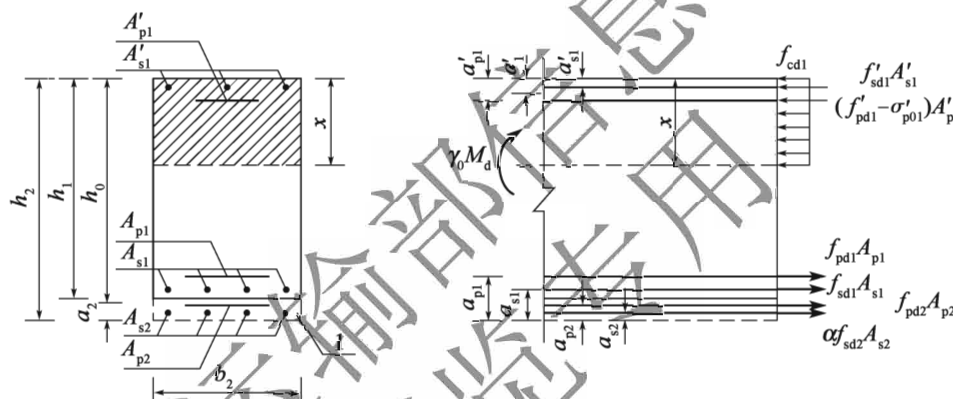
混凝土受弯构件增大截面加固正截面抗弯承载力计算
